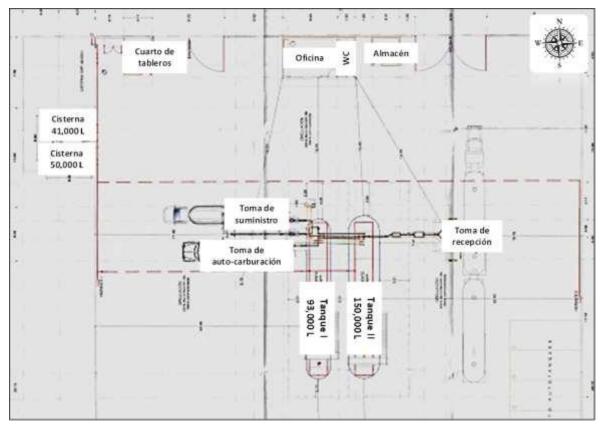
Modificaciones en la planta de distribución de Gas L.P. sucursal Apaseo El Alto. Plano Nº 1/4, Hoja 1/3.
